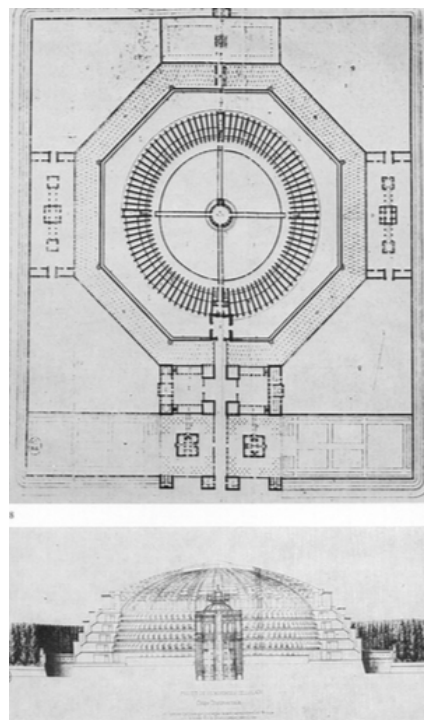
Planta y alzado de la prisión de Harou-Romain
